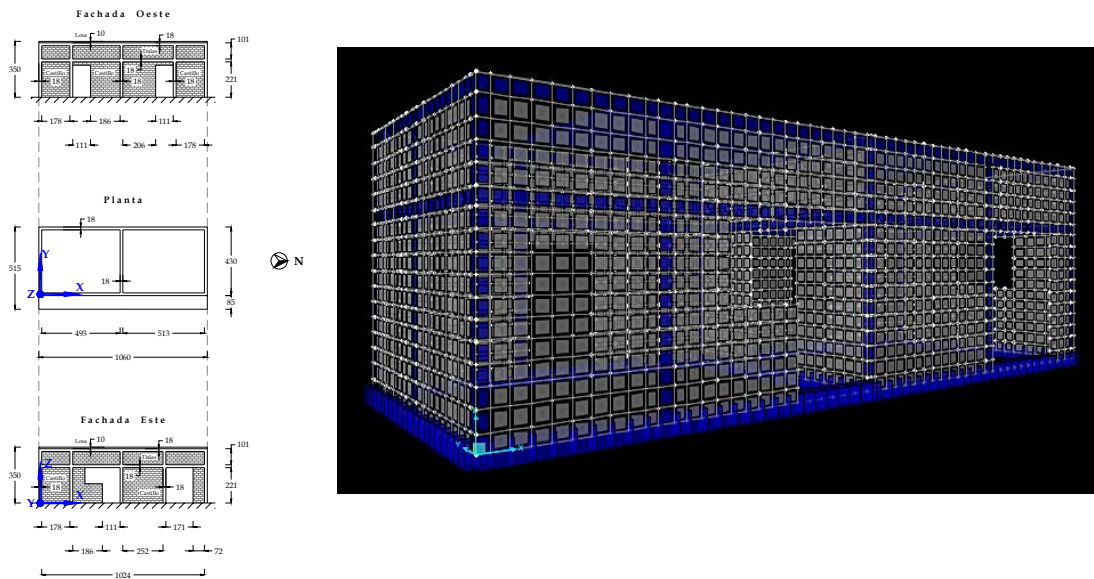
Modelo estructural de la vivienda 1.
